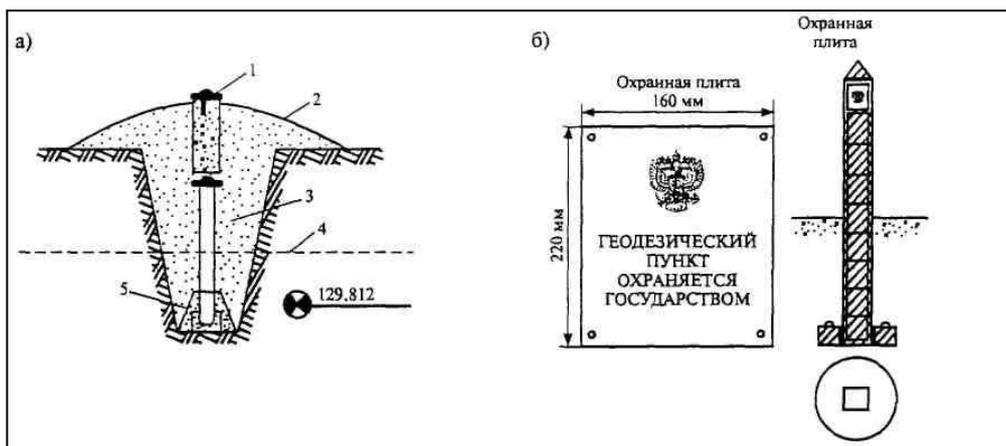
Типы нивелирных реперов: а - капитальный грунтовой репер государственной нивелирной сети; б - железобетонный опознавательный столб
